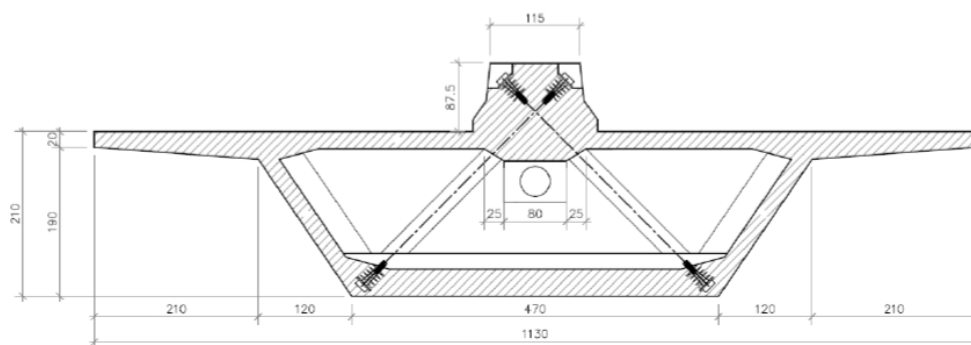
Seção transversal celular de concreto - Ponte do Saber no Rio de Janeiro (GOMES, 2013)
